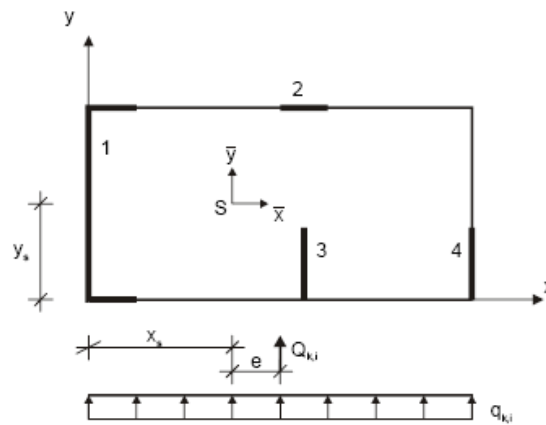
Grundriss mit unregelmäßig angeordneten Aussteifungselementen
